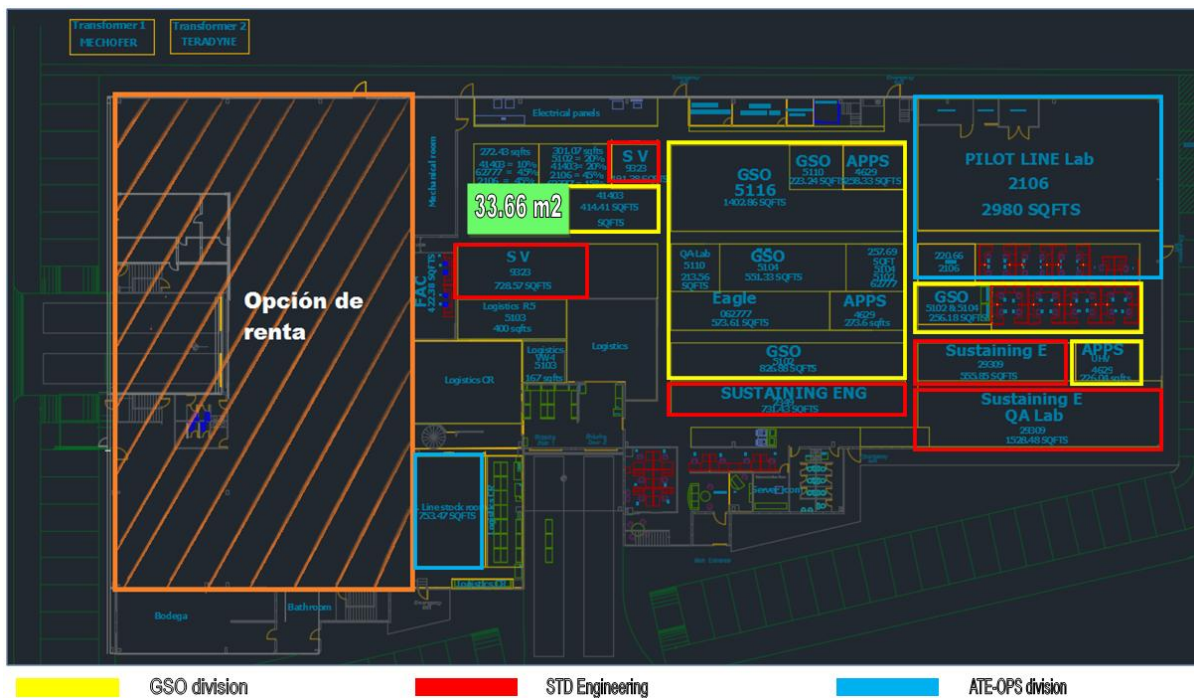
Distribución de planta por divisiones en edificio D-18
